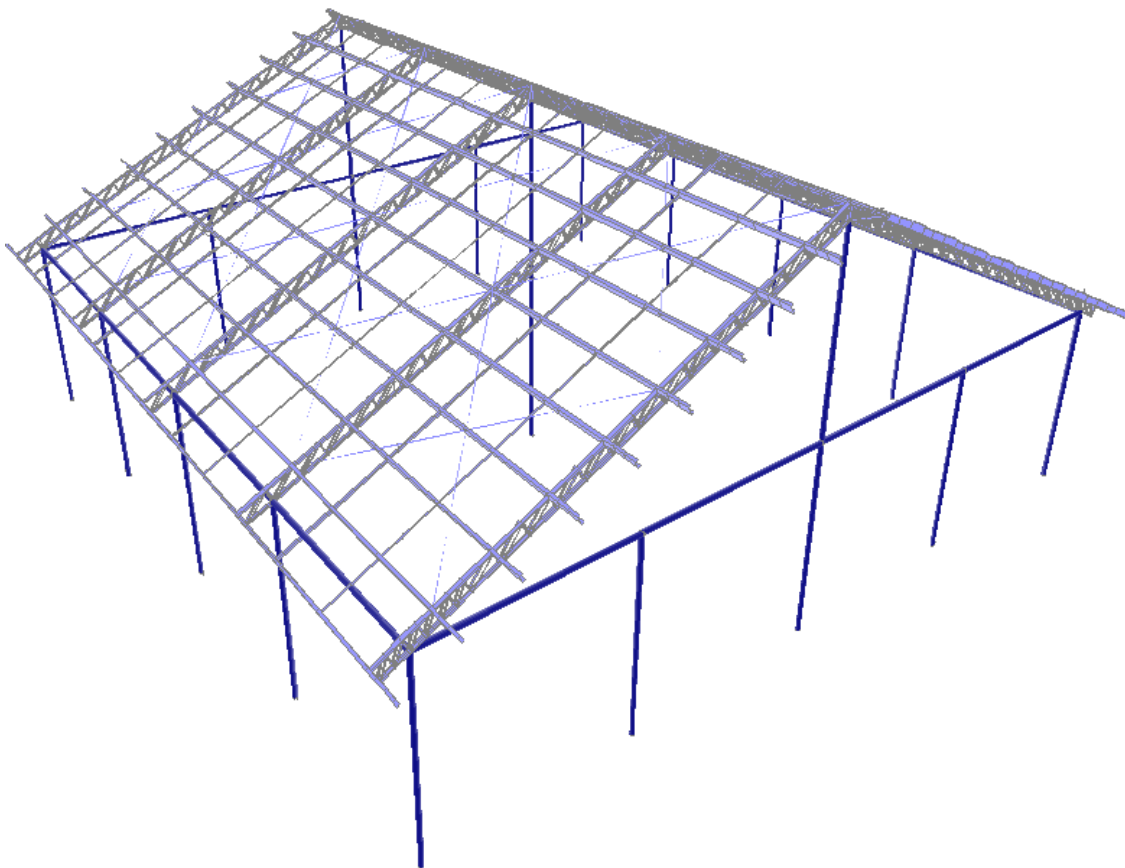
Estructura parabólica en celosía con columnas metálicas
